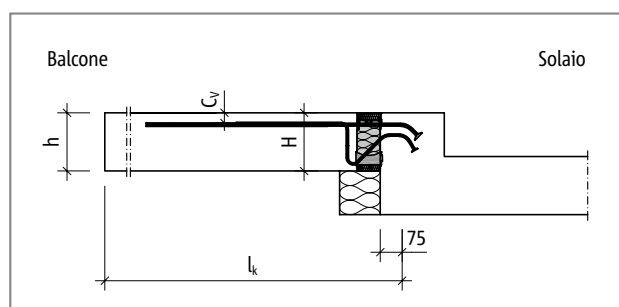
Schöck Isokorb® T tipo KL-O: schema statico
